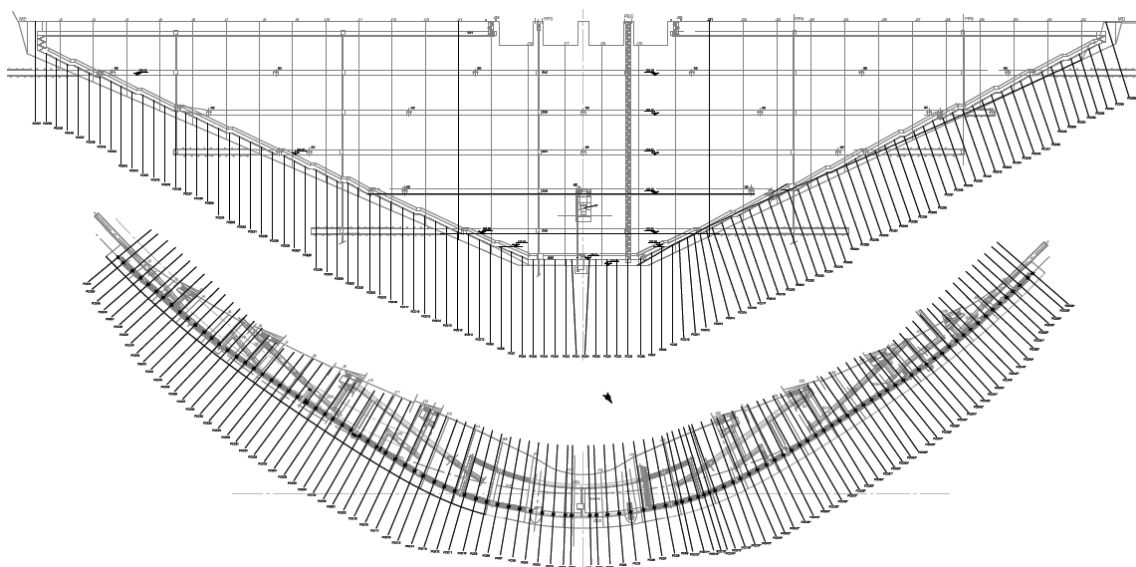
Representação da furação de consolidação em corte e em planta de corte longitudinal respetivamente
